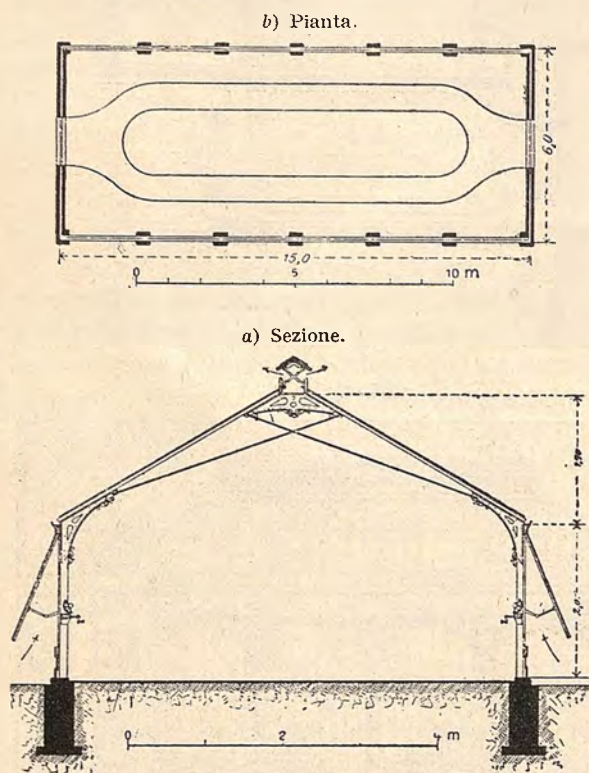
a, b. — Serra per la coltivazione della frutta, in Altona (arch. Zimmermann).
